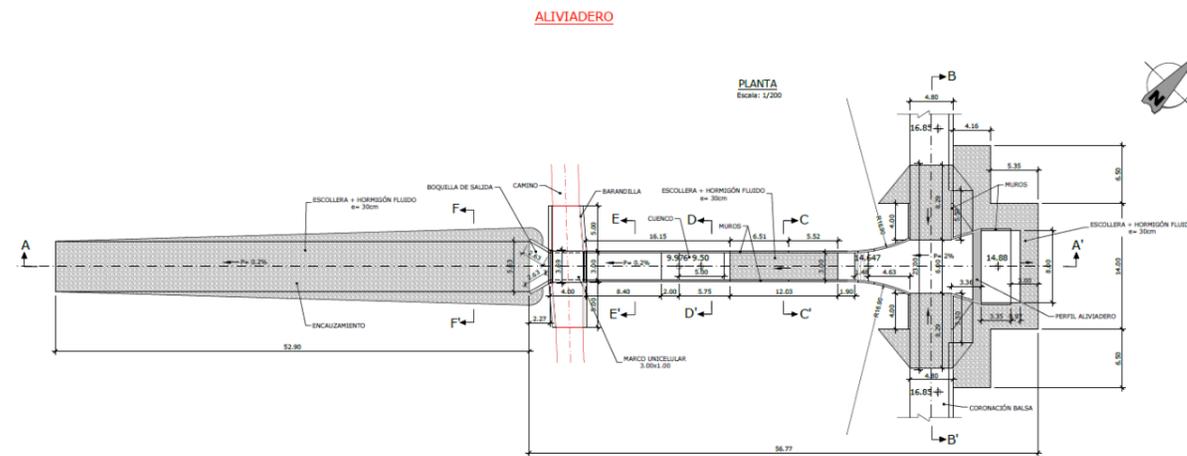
Aliviadero bolsa de regulación. Planta. S, Alcantarillas
